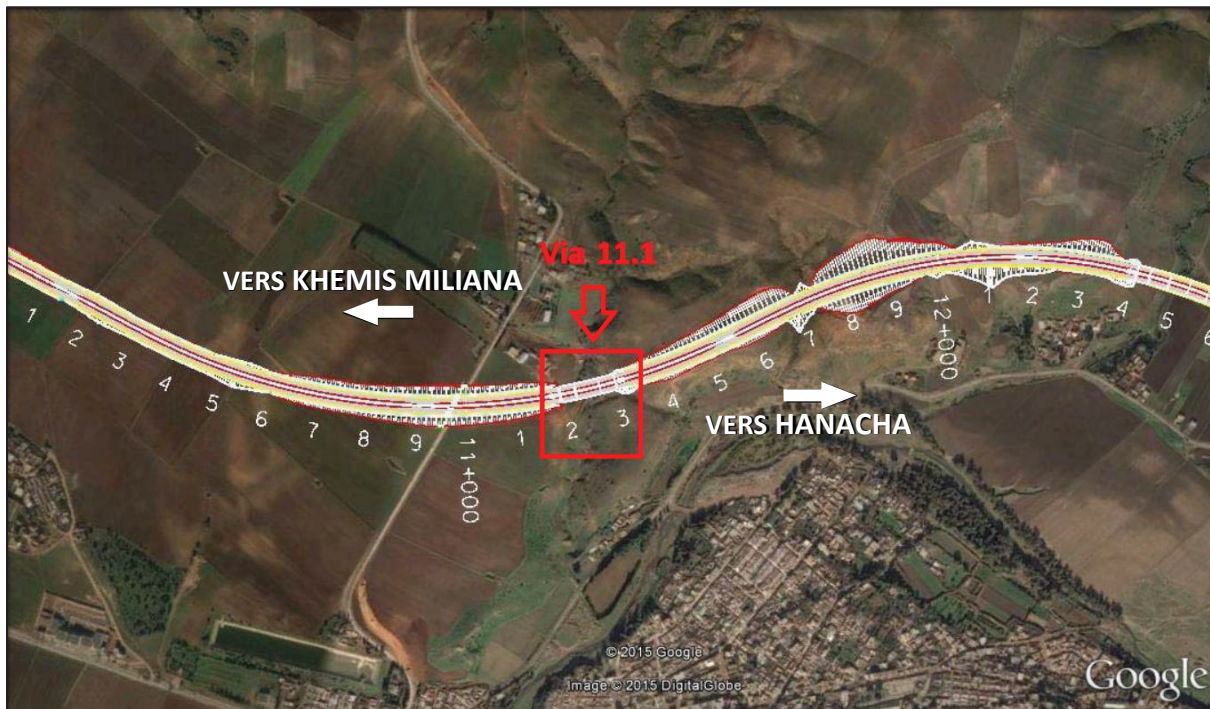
Image satellitaire sur la position de l'ouvrage.
